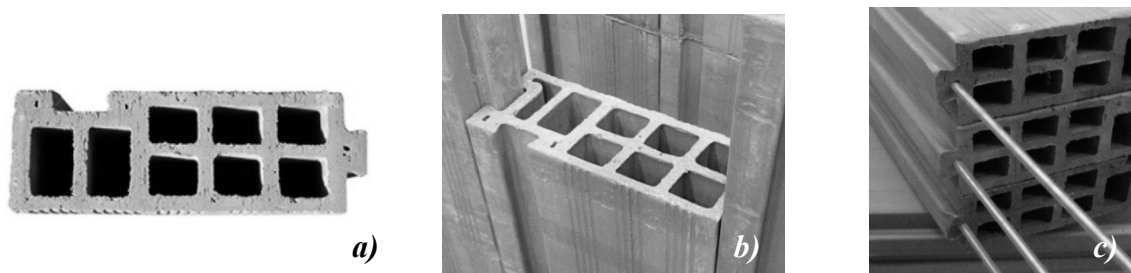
Tijolo *UNIKO*; a) Geometria do tijolo *UNIKO*; b) Pormenor da junta de encaixe no tijolo *UNIKO*; c) Aplicação de varões metálicos no tijolo *UNIKO* [56].
